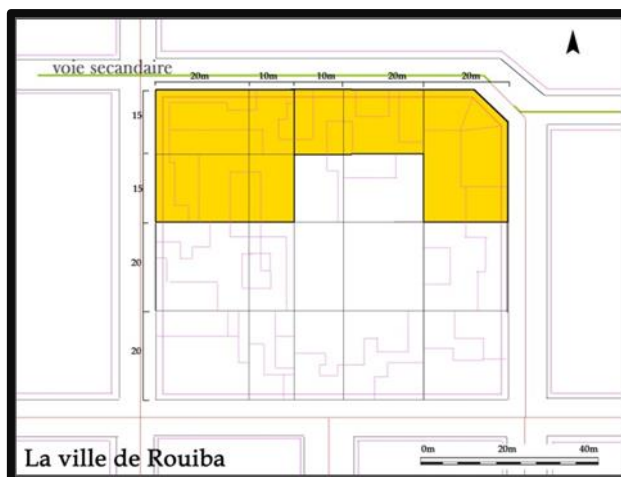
Plan des parcelles donnant sur la voie secondaire
